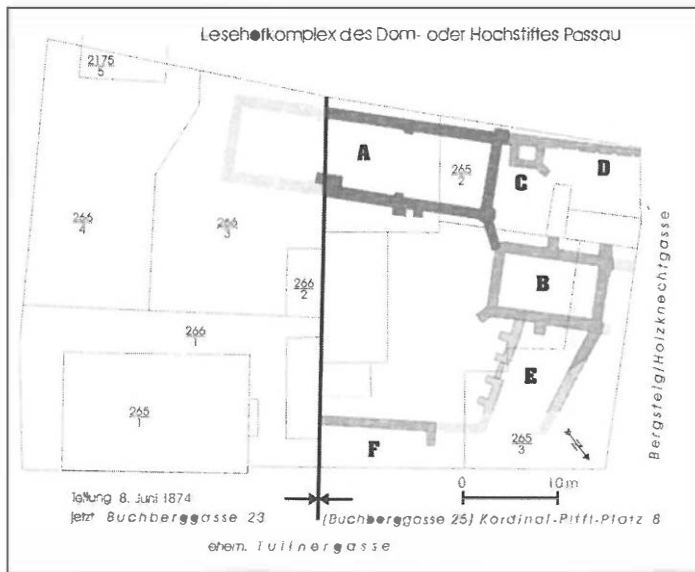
Klosterneuburg, Passauerhof. Grundriss der ergrabenen Gebäude. Aus: Koch: *Baugeschichte* (wie Anm. 62), S. 73. A: Saalbau („Chorhof“/„Stainhaus“), B: Kapelle (bei Koch: Kellergebäude), C: Turm, D: Begrenzungsmauer, E: Arkadenbau, F: Quertrakt
